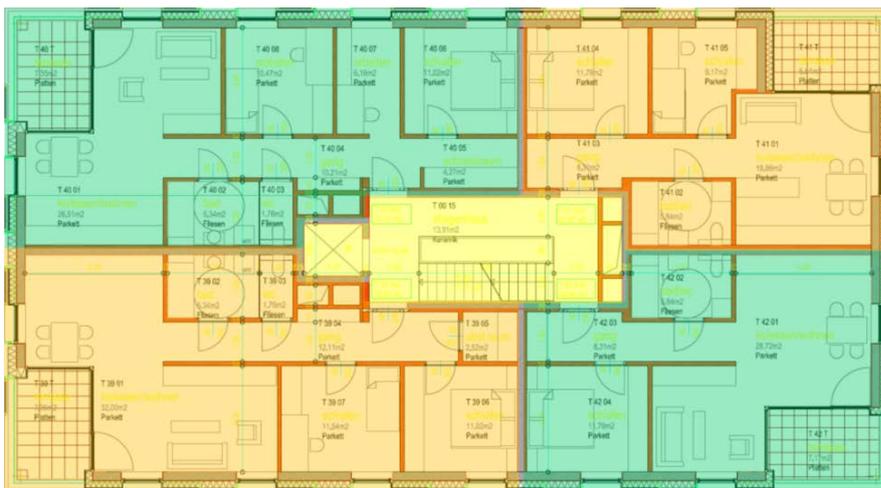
MFH groß – Grundriss Regelgeschoss
